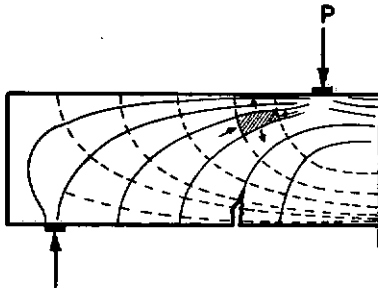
Desenvolvimento das trajetórias de tensão na viga de concreto armado ao aparecimento da primeira fissura de cisalhamento.
